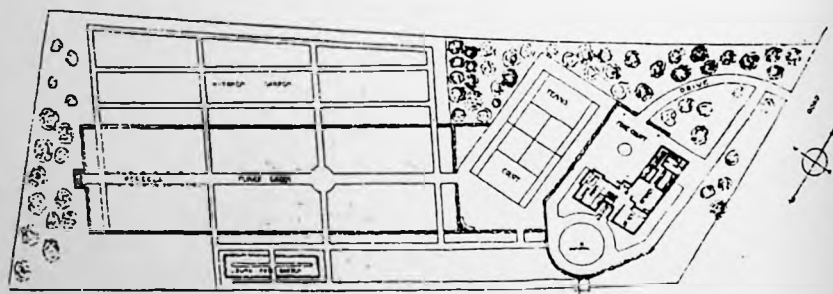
Parker & Unwin, "Crossway cottage", Hampstead, vista e planta
